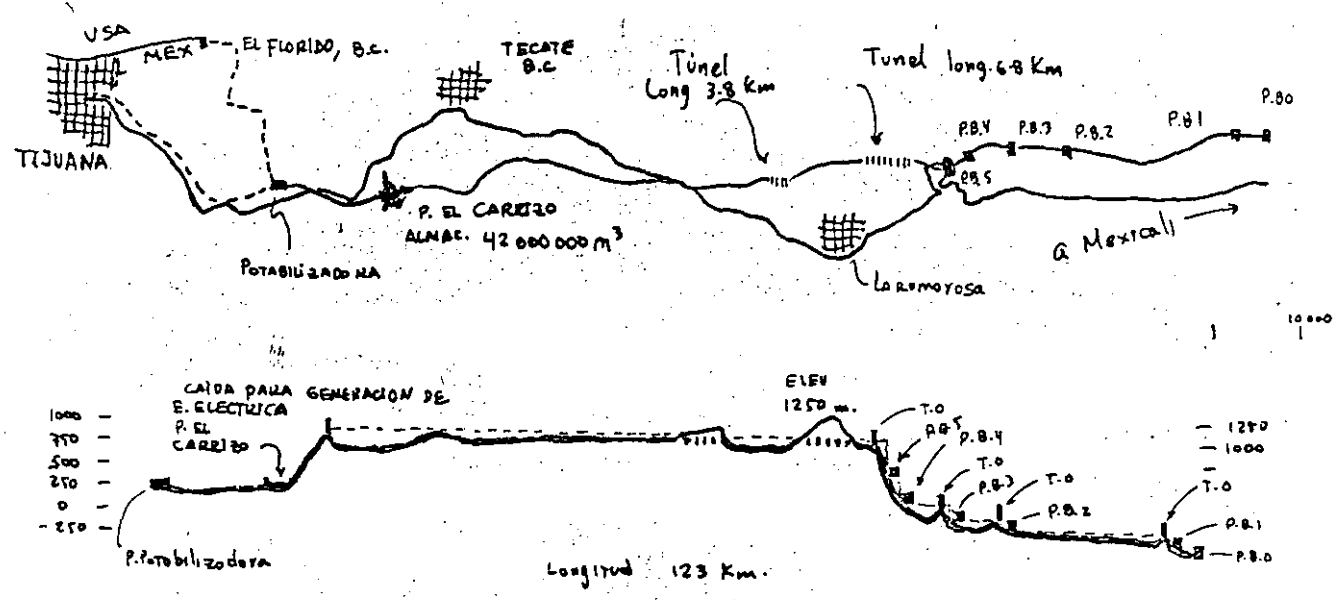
Planta y perfil esquemático del acueducto Rio Colorado - Tijuana. B.C.
